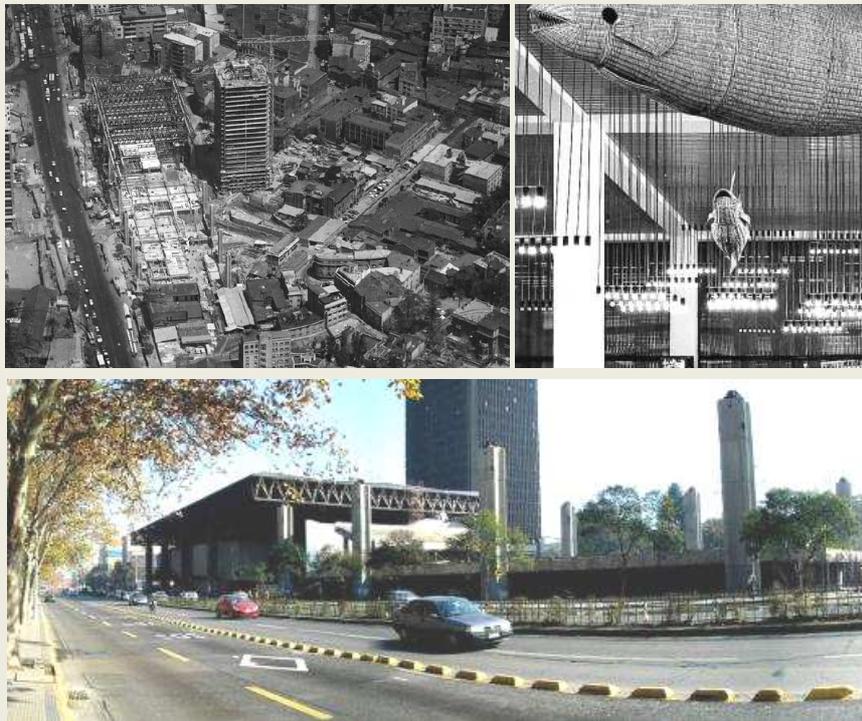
Arriba: Emplazamiento del Edificio para la UNCTAD III durante su construcción, y su interior alhajado con arte. Fuente: Maulen 2006:82-88. Abajo: Edificio Diego Portales posterior el incendio de 2006, donde se aprecia su aspecto "frío", con vigas de color oscuro y volúmenes herméticos hacia la Alameda. Fuente: [www.plataformaurbana.cl](http://www.plataformaurbana.cl).
